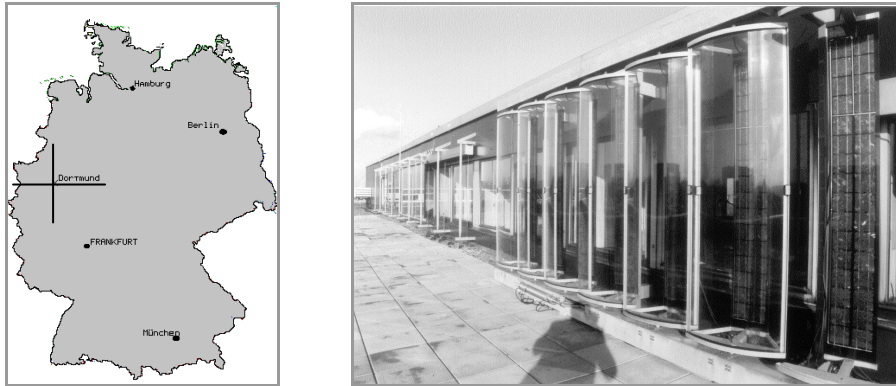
(oben): a: Lage Dortmunds und b: Außenansicht der Testfassade
